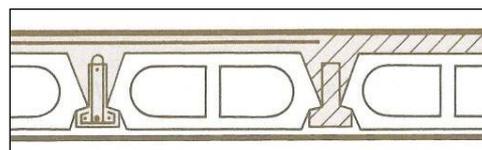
Rippendecke mit Betonfertigteilen, Aufbeton und nicht tragenden Füllkörpern, Bildnachweis [1b]
